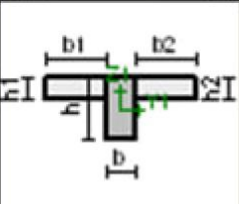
Розрахункова схема плити перекриття з розміщенням балок
